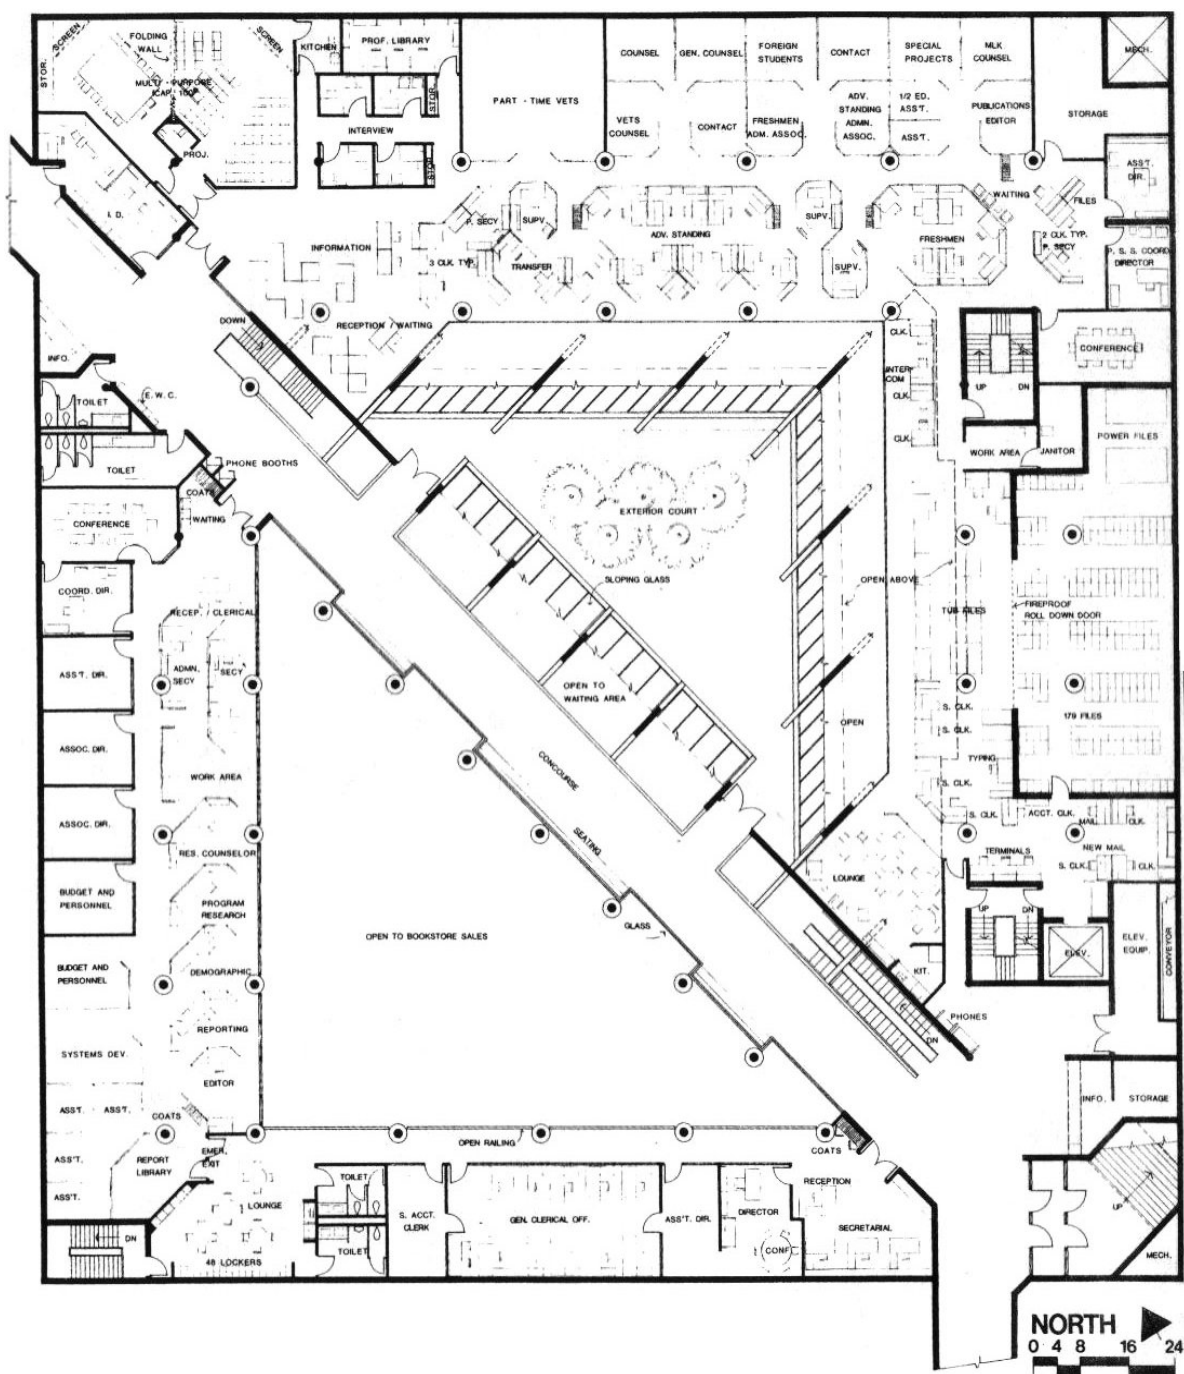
План первого подземного этажа здания Williamson Hall
